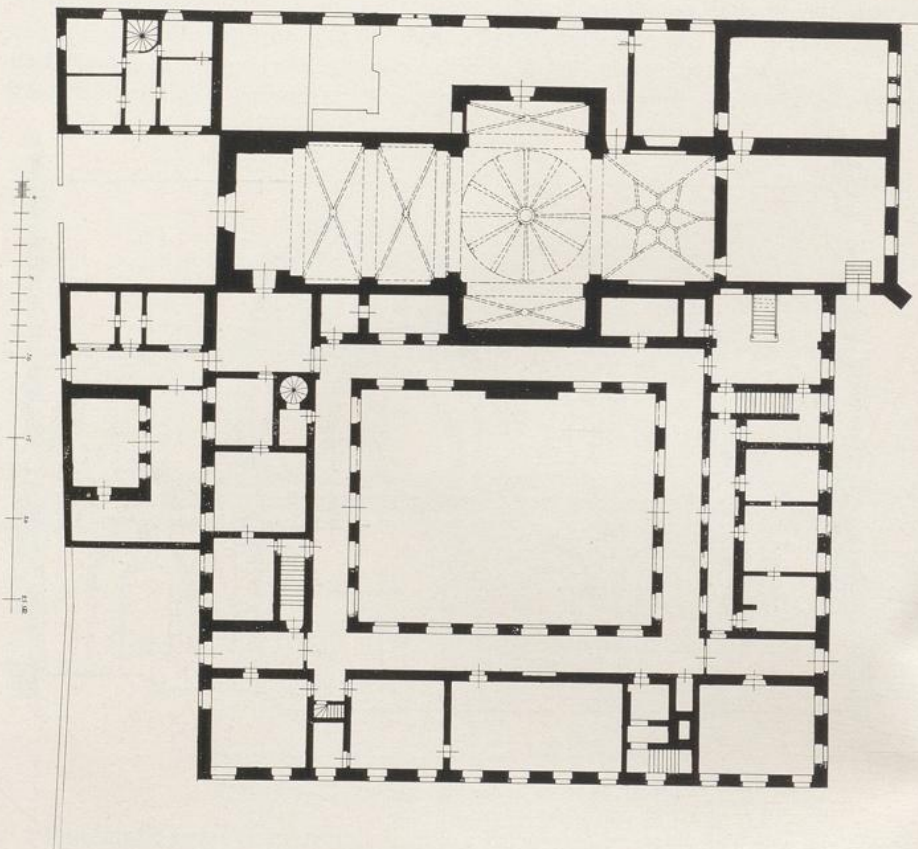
St. Maria in der Schnurgasse. Grundriss des ehem. Klosters (nach einem Plan vom Anf. d. 19. Jh.).
